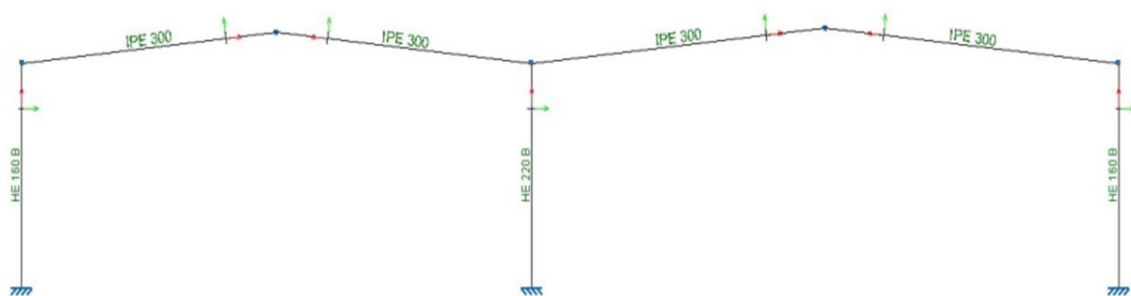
Distribución de pórticos de fachada e intermedios en acero.
